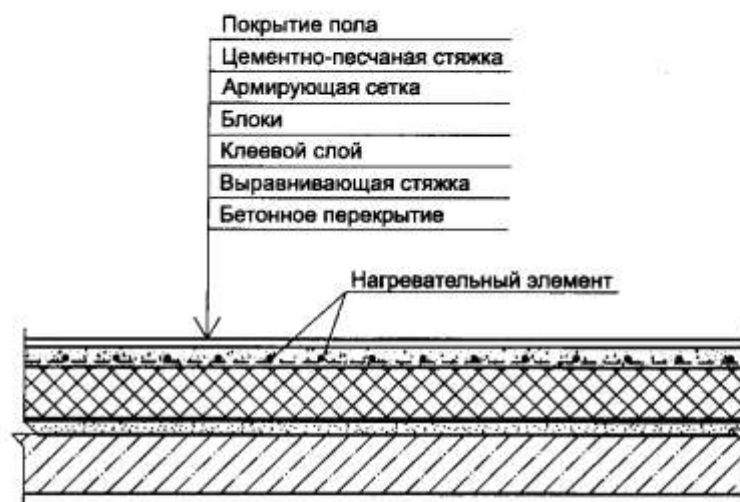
Тепловая изоляция пола из блоков по перекрытию
